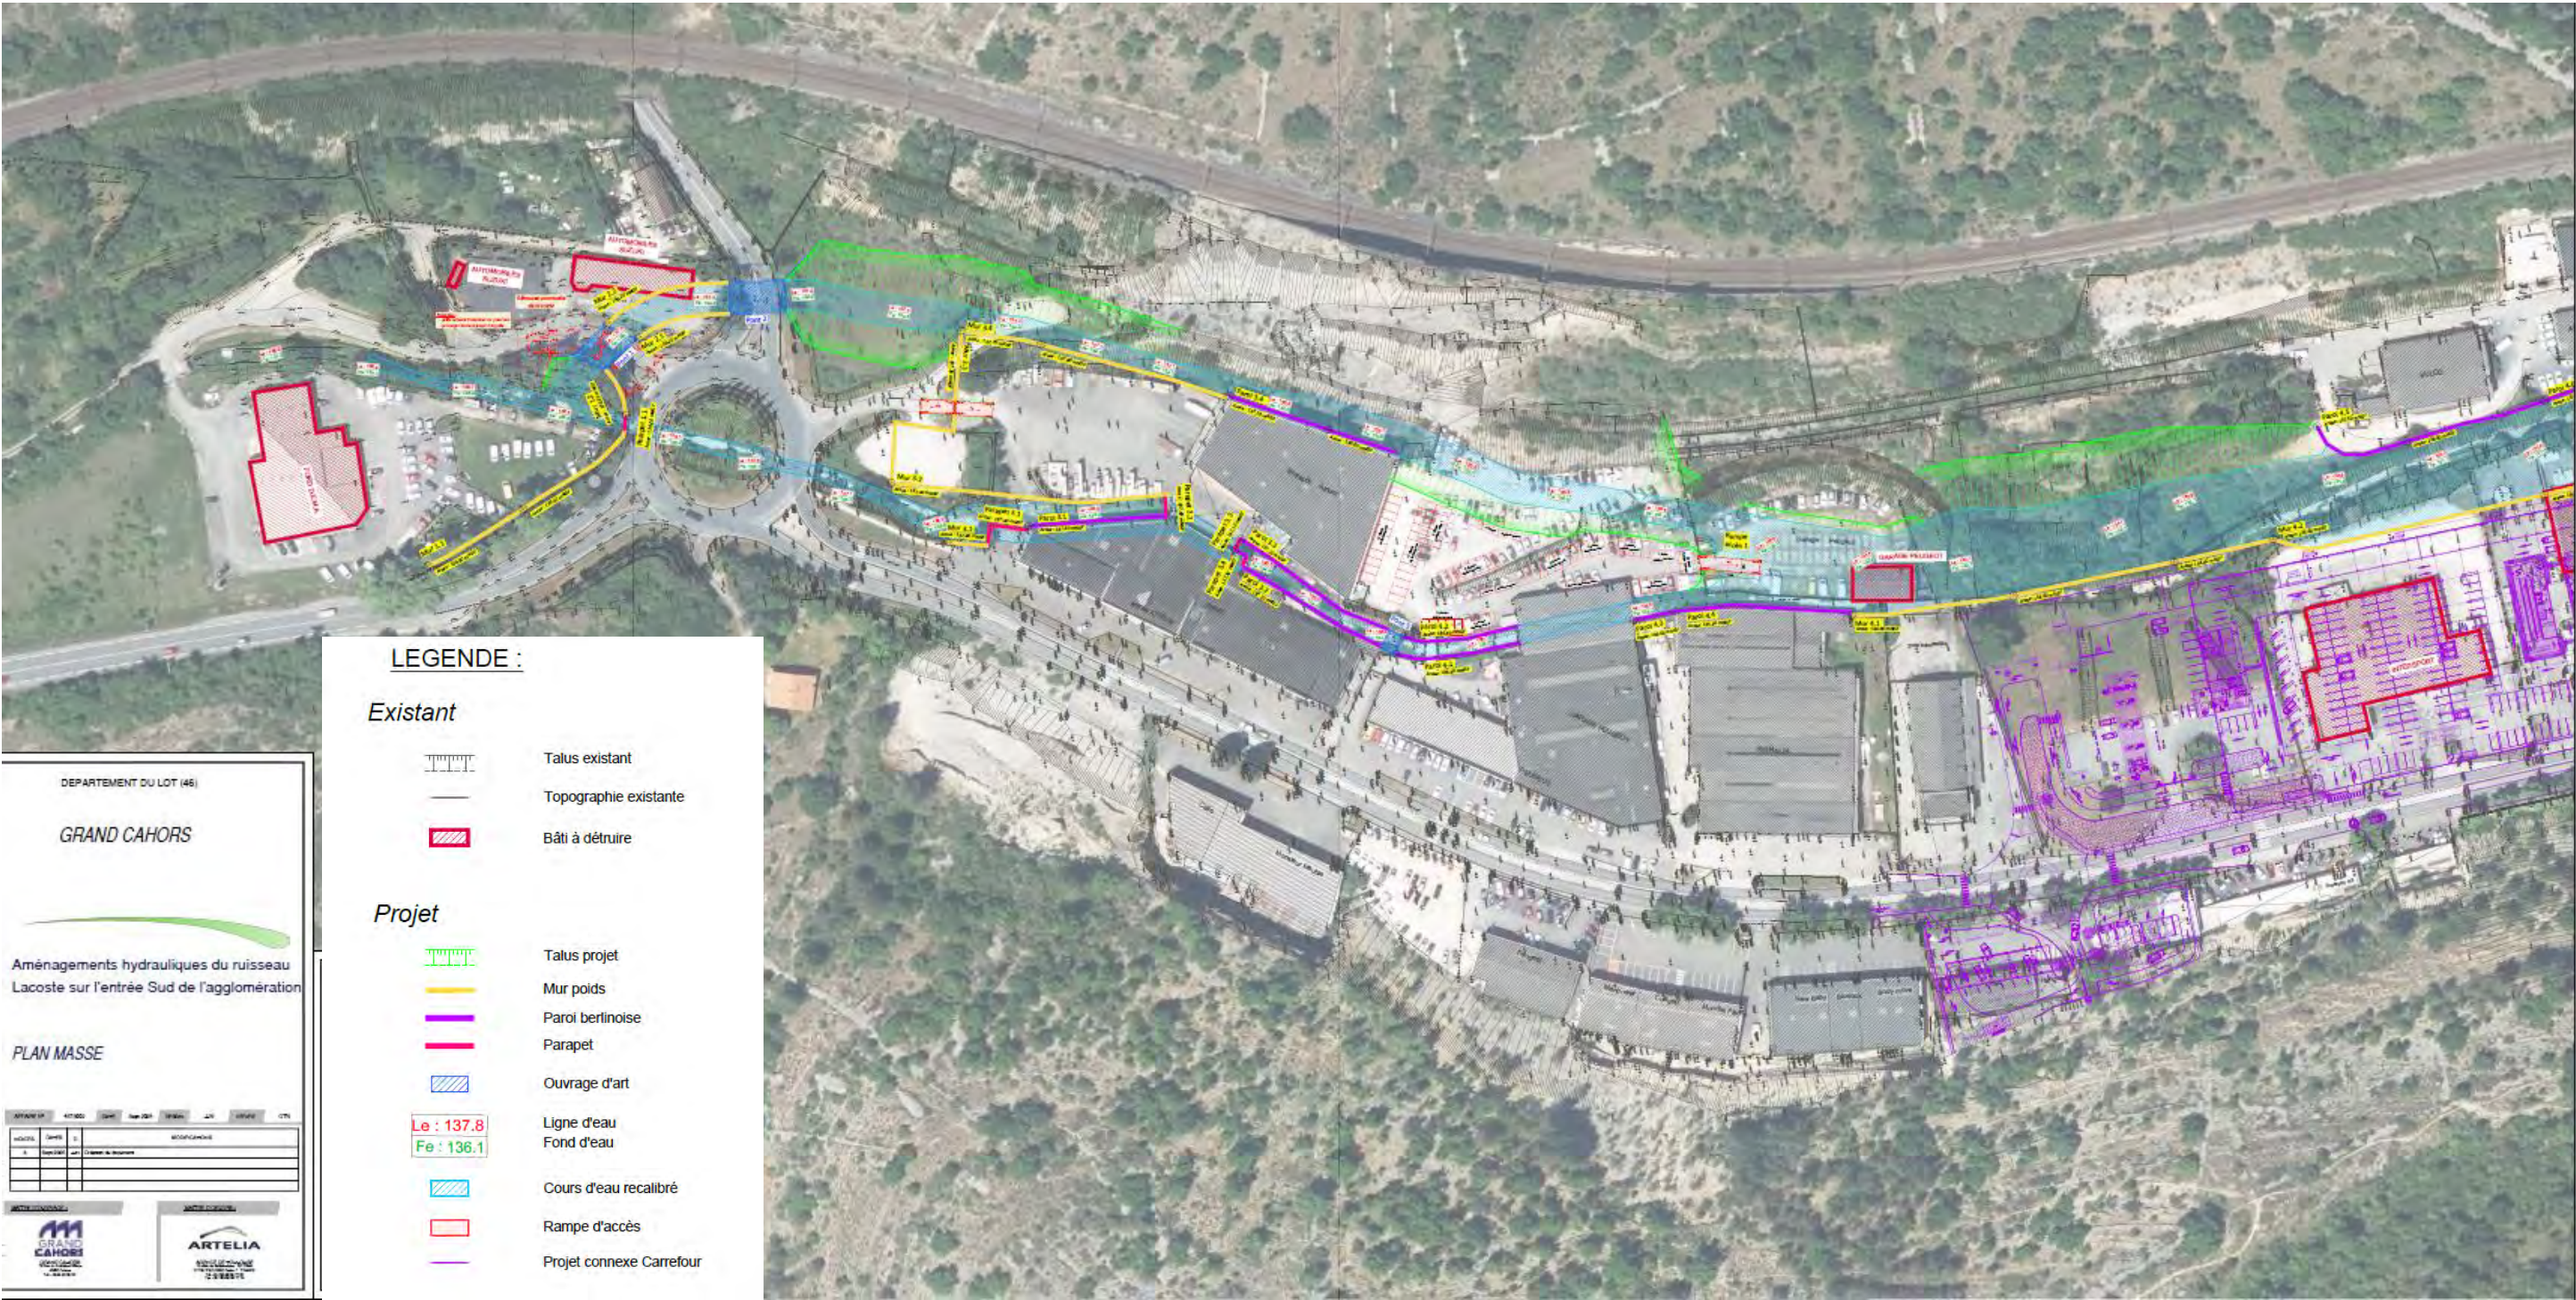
Plan des aménagements projetés – Planche 1 sur 3
